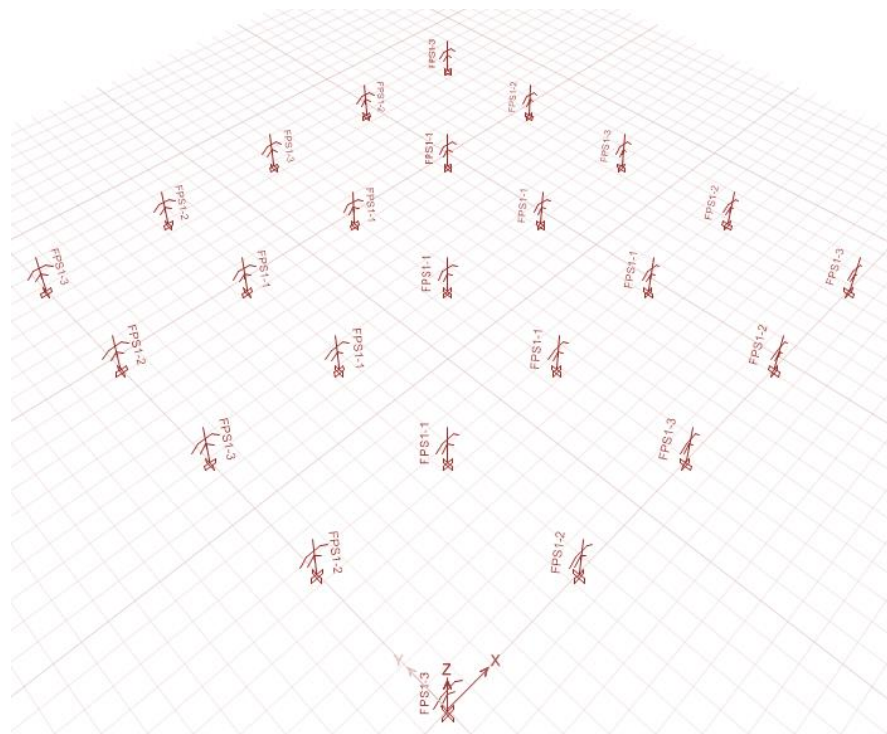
Distribución en Planta Aisladores tipo FPS (Microzona Piedemonte C). Fuente: Propia.
